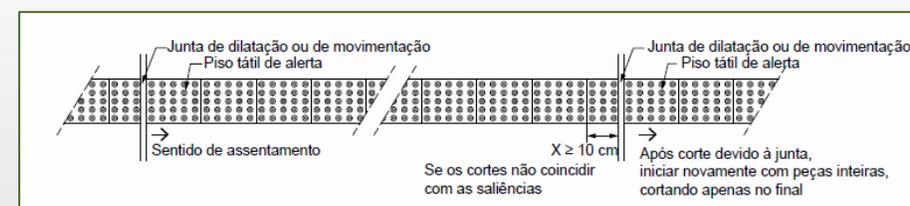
Corte e emenda de piso tátil alerta corte de uma peça
